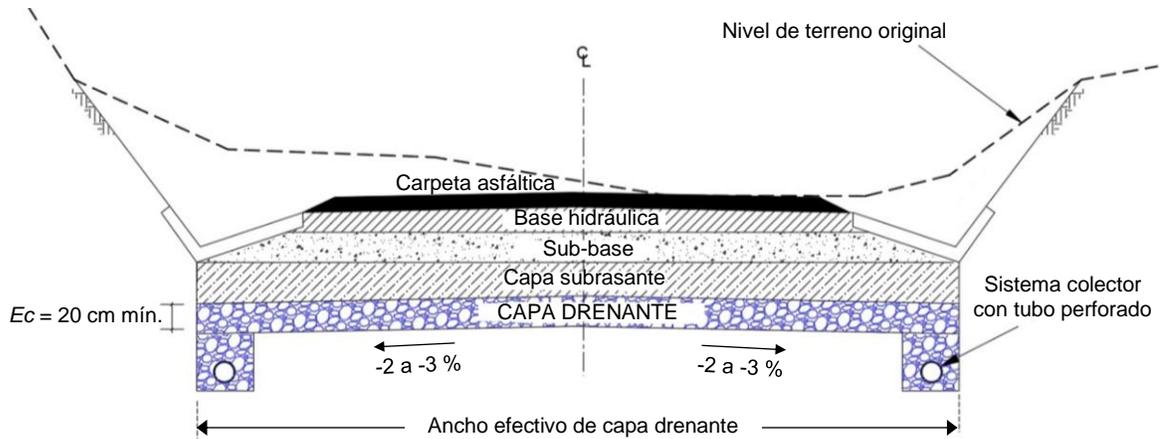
Perfil estratigráfico para ubicar una capa drenante de protección para una estructura de pavimento
